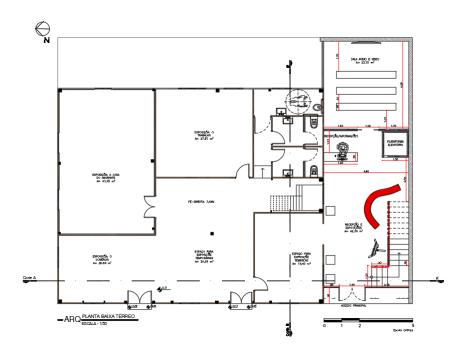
Planta baixa térreo. Fonte: Arq. Urb. Me. Adilson Giglioli.
